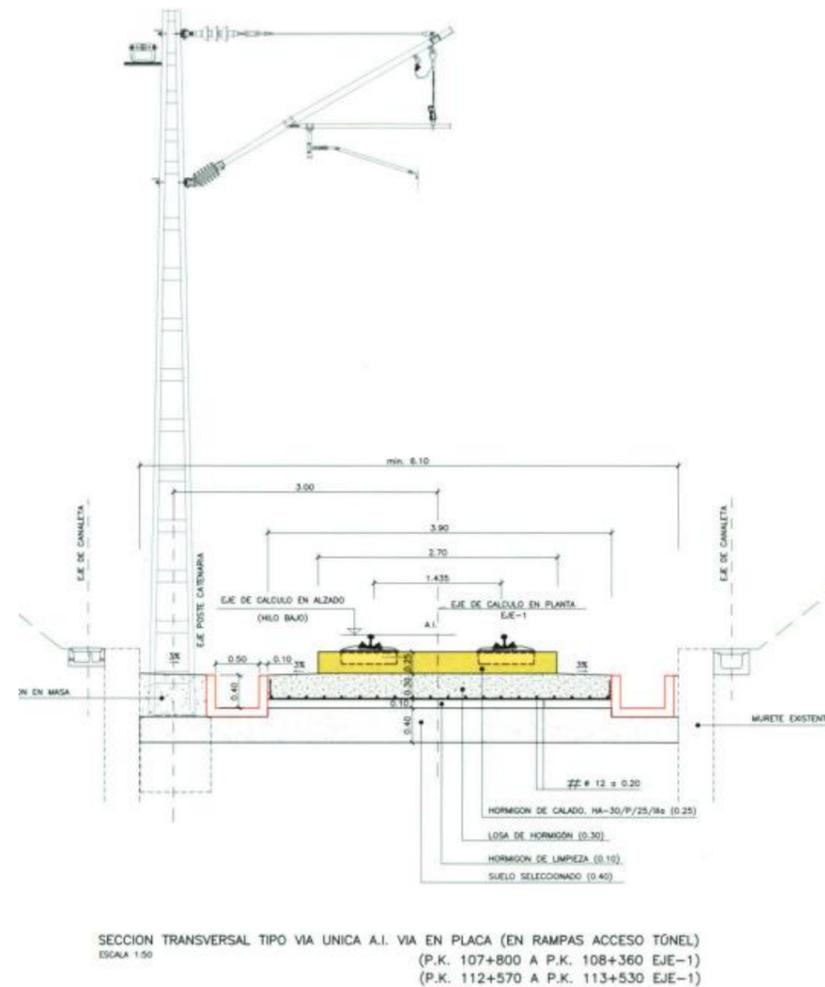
SECCIÓN TRANSVERSAL EN RAMPAS DE ACCESO A TÚNEL
